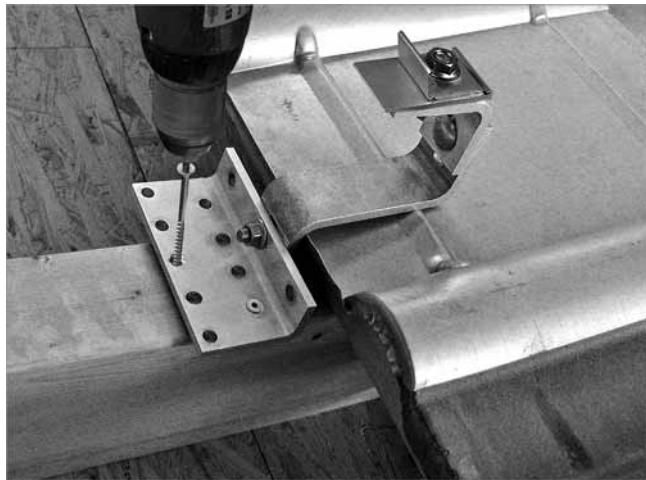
Fissaggio del supporto per il montaggio sul tetto
